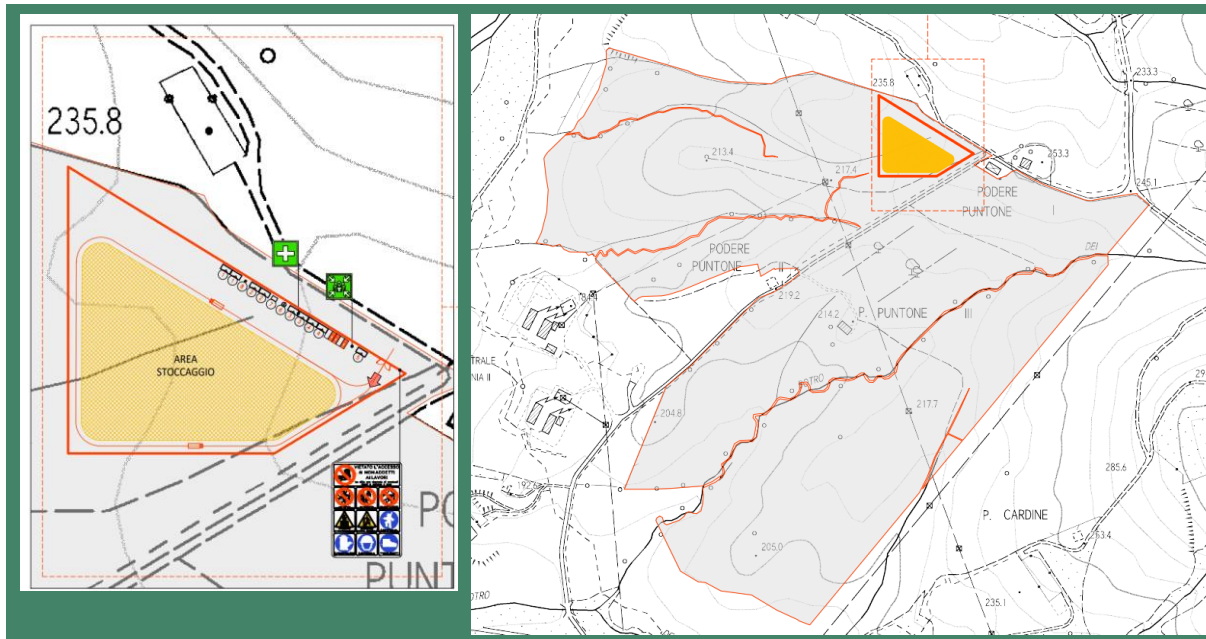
Stralci delle aree di stoccaggio di cantiere.
